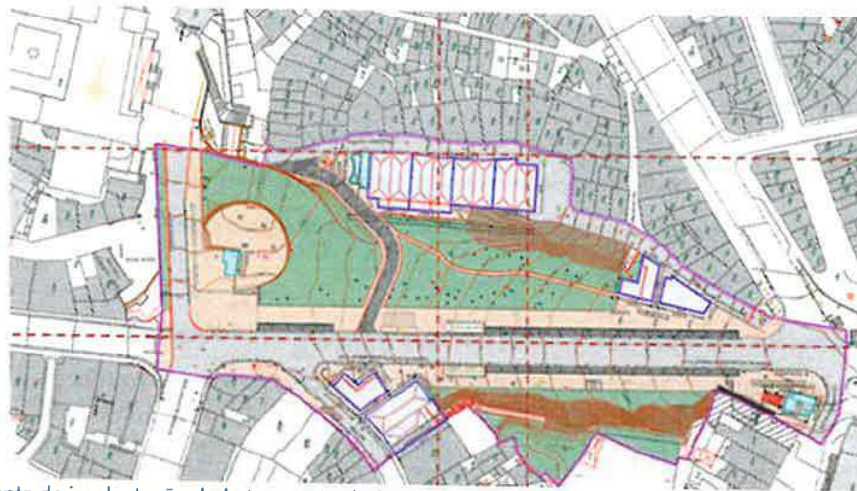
Planta de implantação do Loteamento da Av. da Ponte
